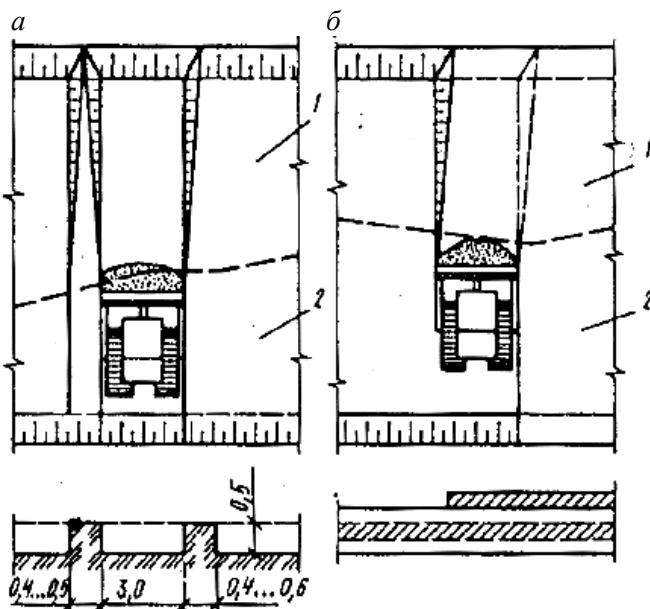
Схема резания и перемещения грунта бульдозером:
